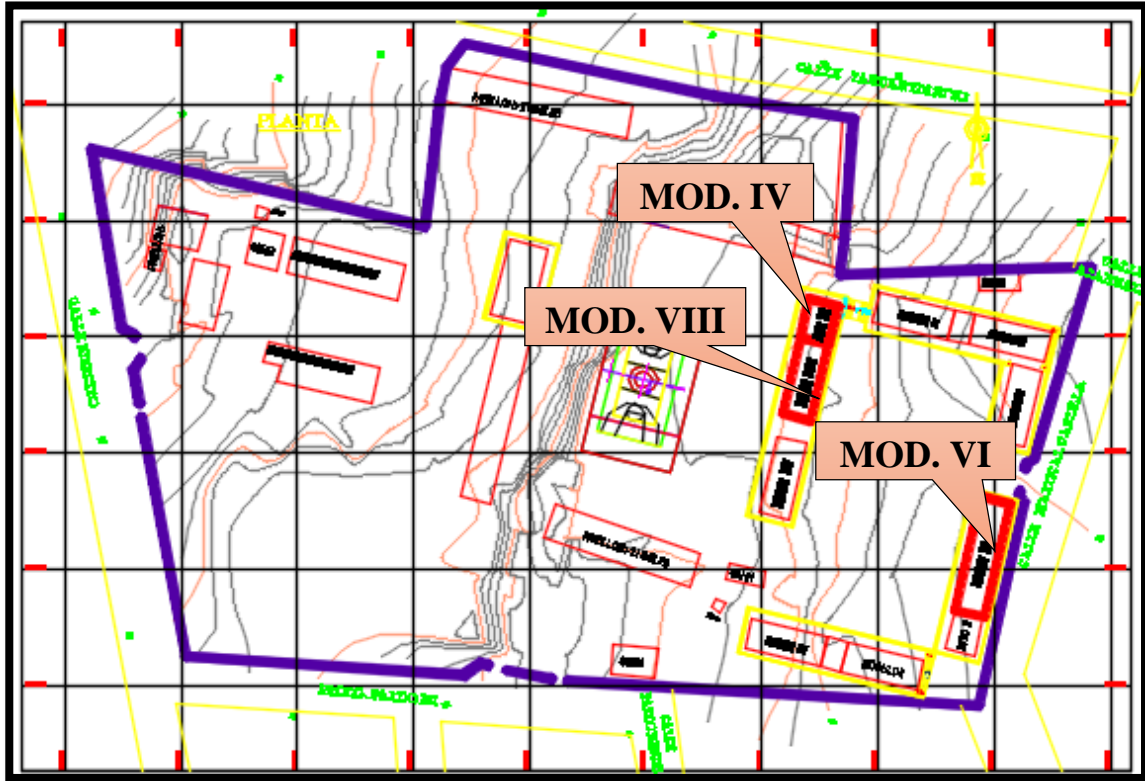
Plano de la planta general de la IE Alfonso Villanueva Pinillos: Ubicación de los Módulos IV, VI y VIII
